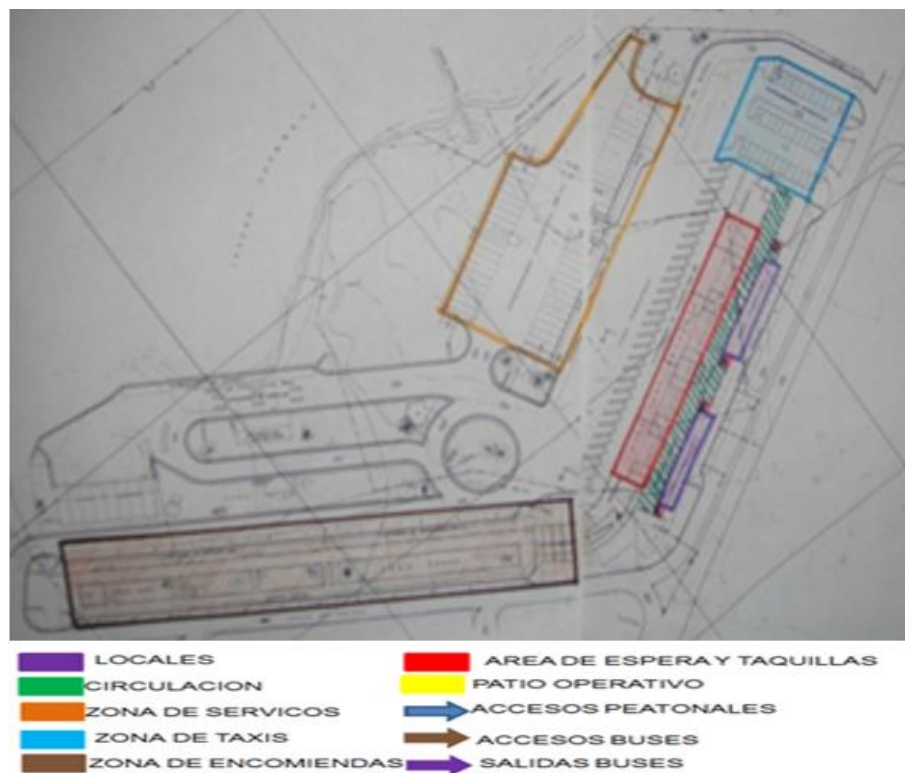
Zonas del terminal transporte de Cartagena. Adaptado de Plano publicado en la revista Escala 63.
